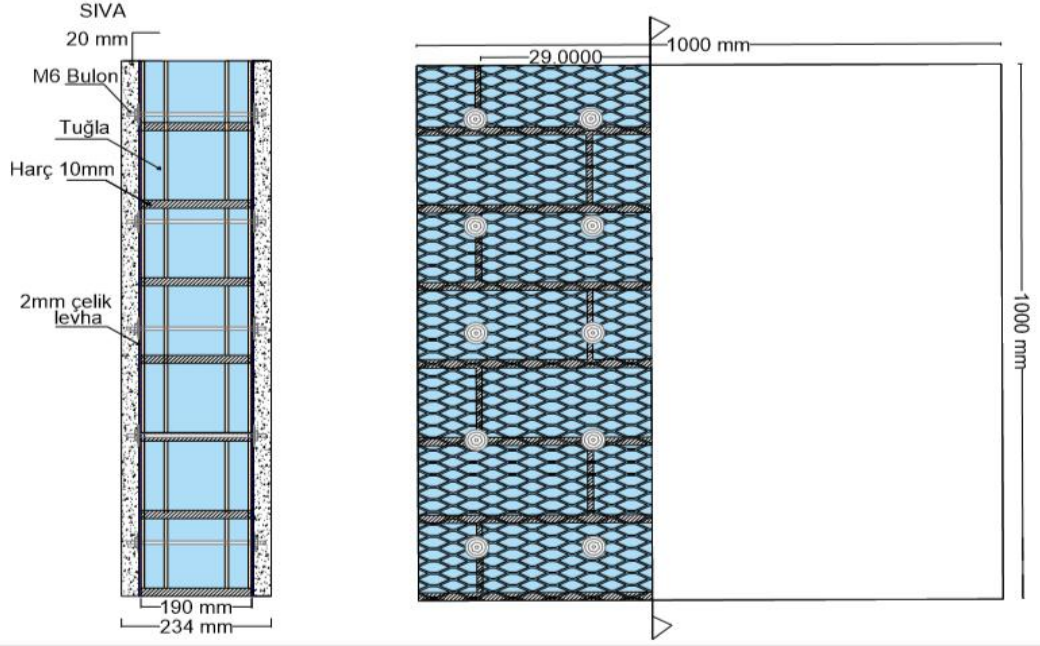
MBW 3,0-200 deney elemanının boyutları ve güçlendirme detayları
